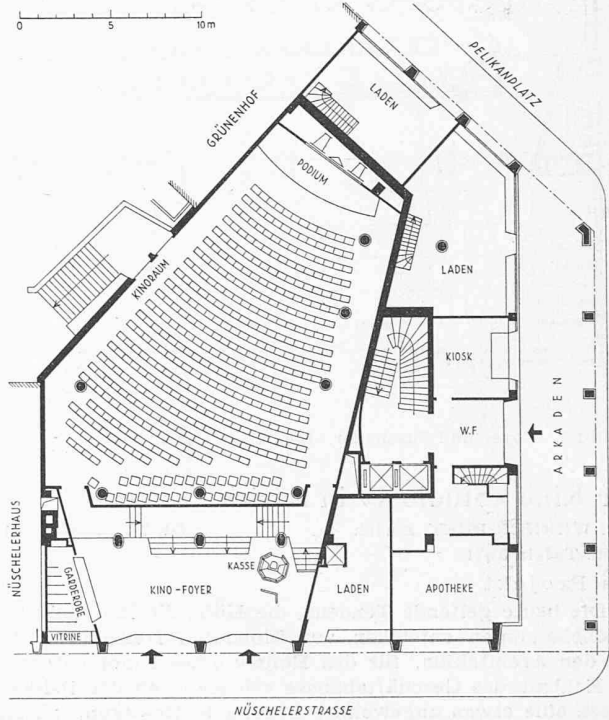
Erdgeschoss mit Kinoraum und Läden, 1 : 400
